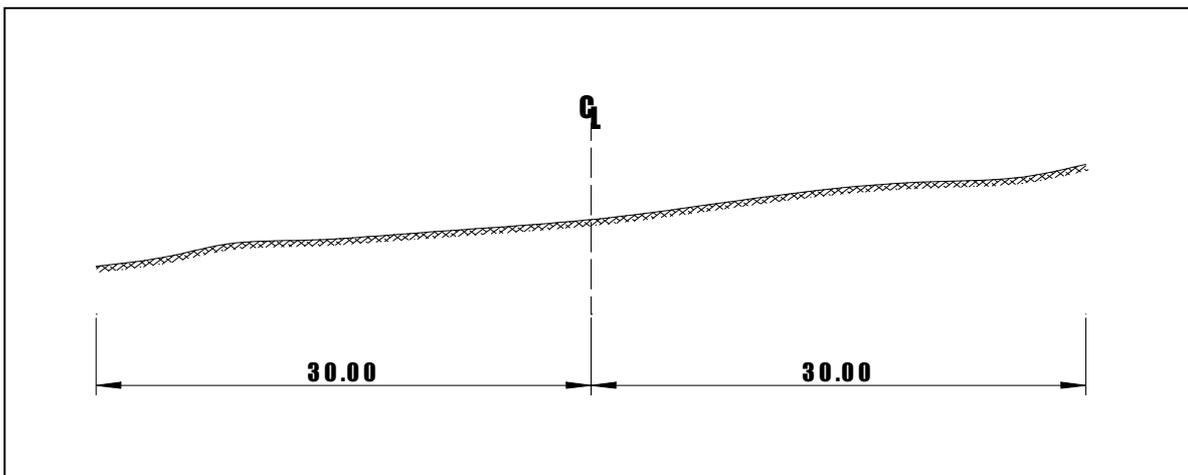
SECCIÓN TRANSVERSAL PRELIMINAR
